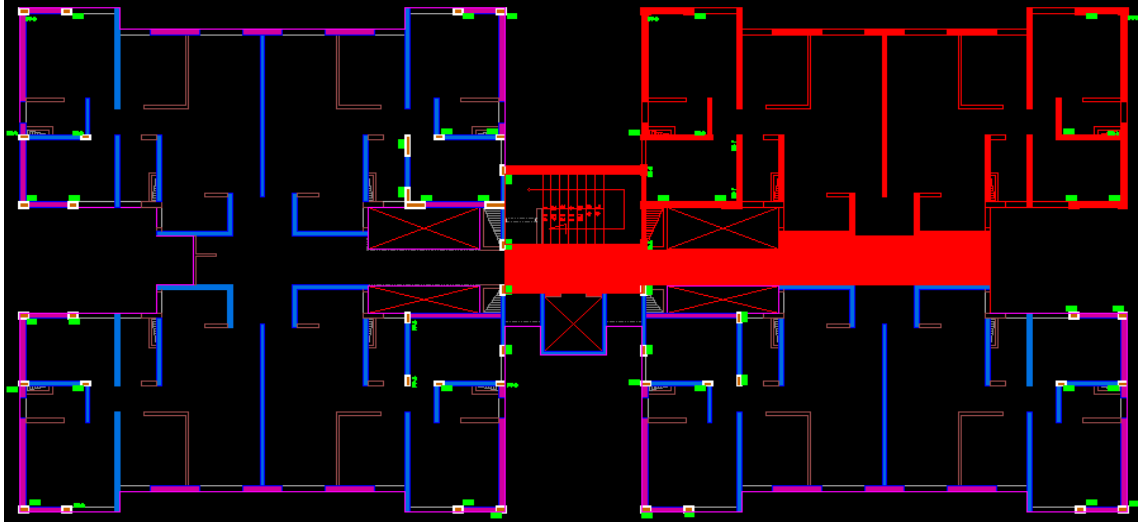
Cuarta fundición: apartamentos 5 y 6, muro de 30 cm y losa 2.
